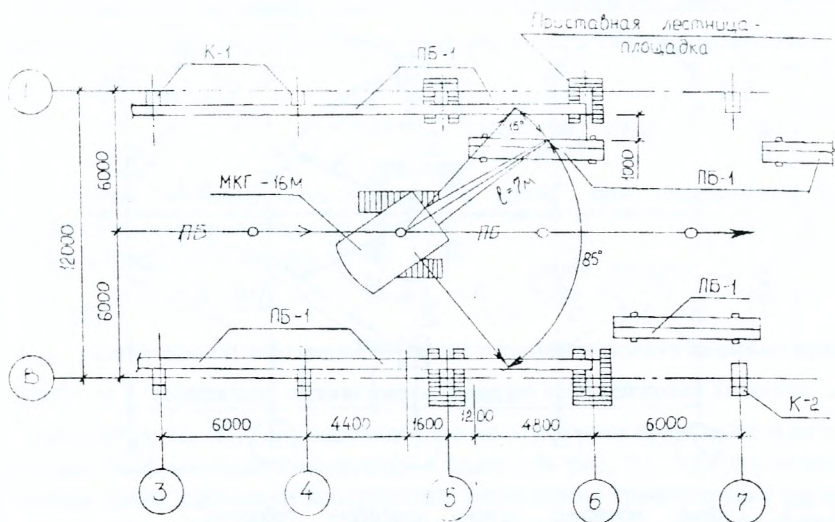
Схема монтажа подкрановых балок поворотом стрелы крана
